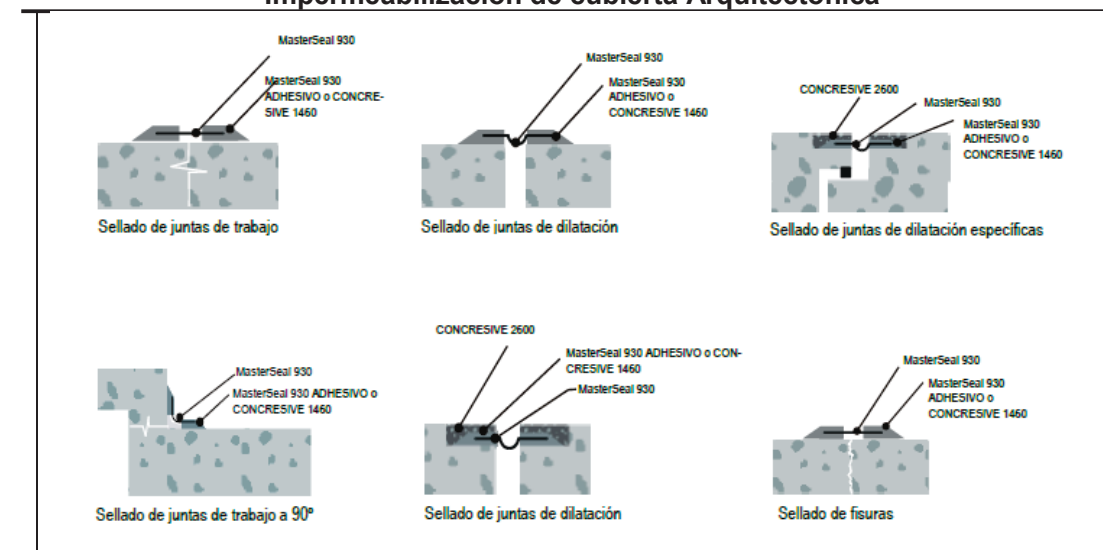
Detalle del tratamiento a realizar en cada junta superior a 30 mm.
